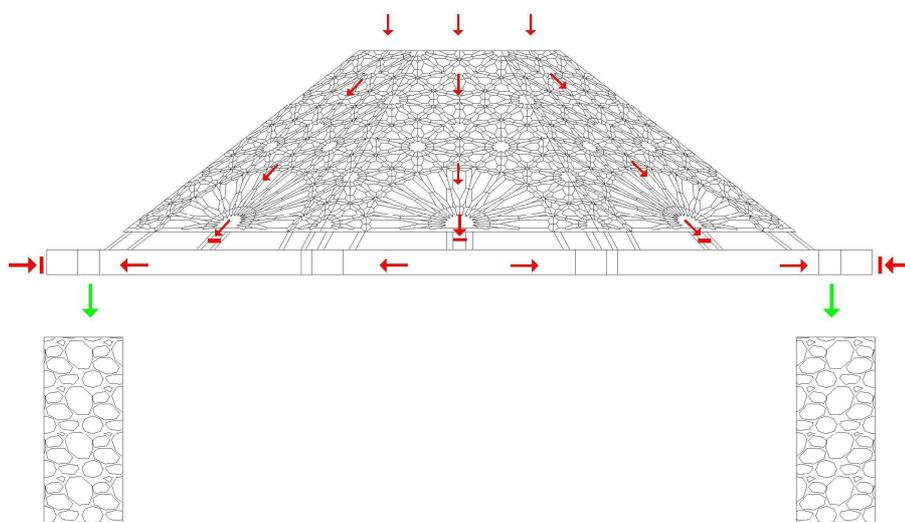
vista del perfil de la armadura y su reparto de cargas y empujes.
